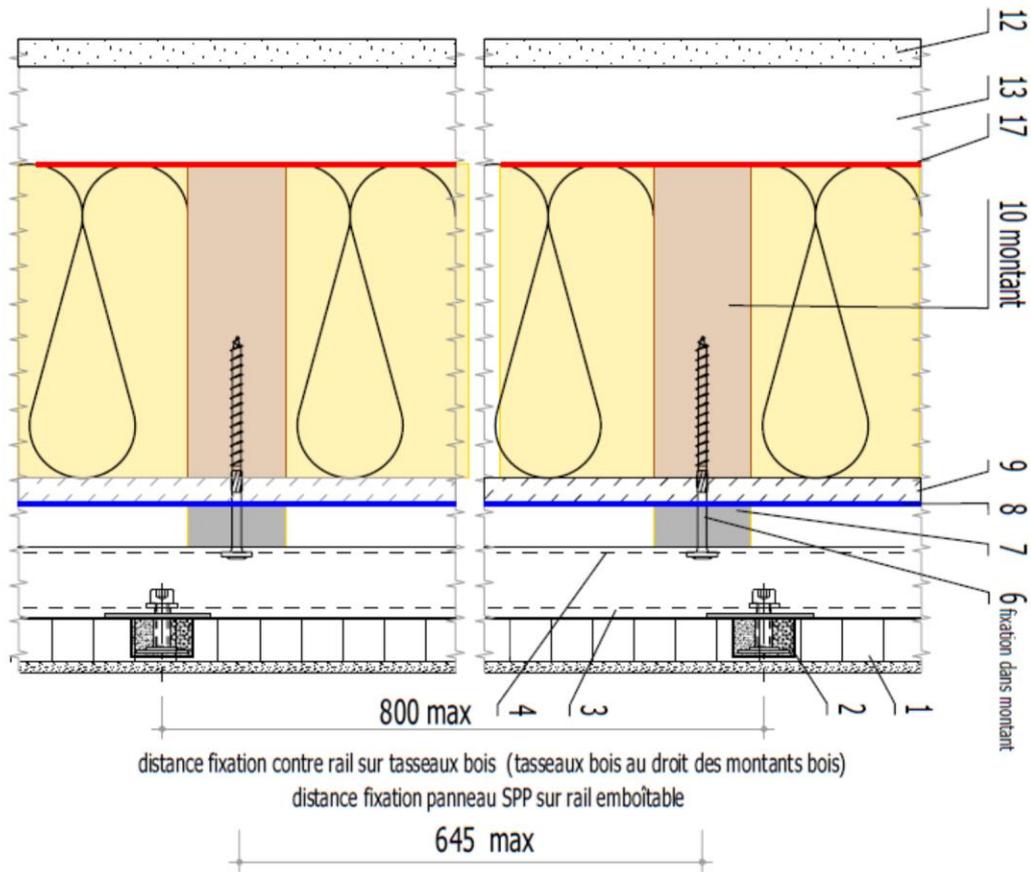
Pose sur COB/CLT - Coupe horizontale
